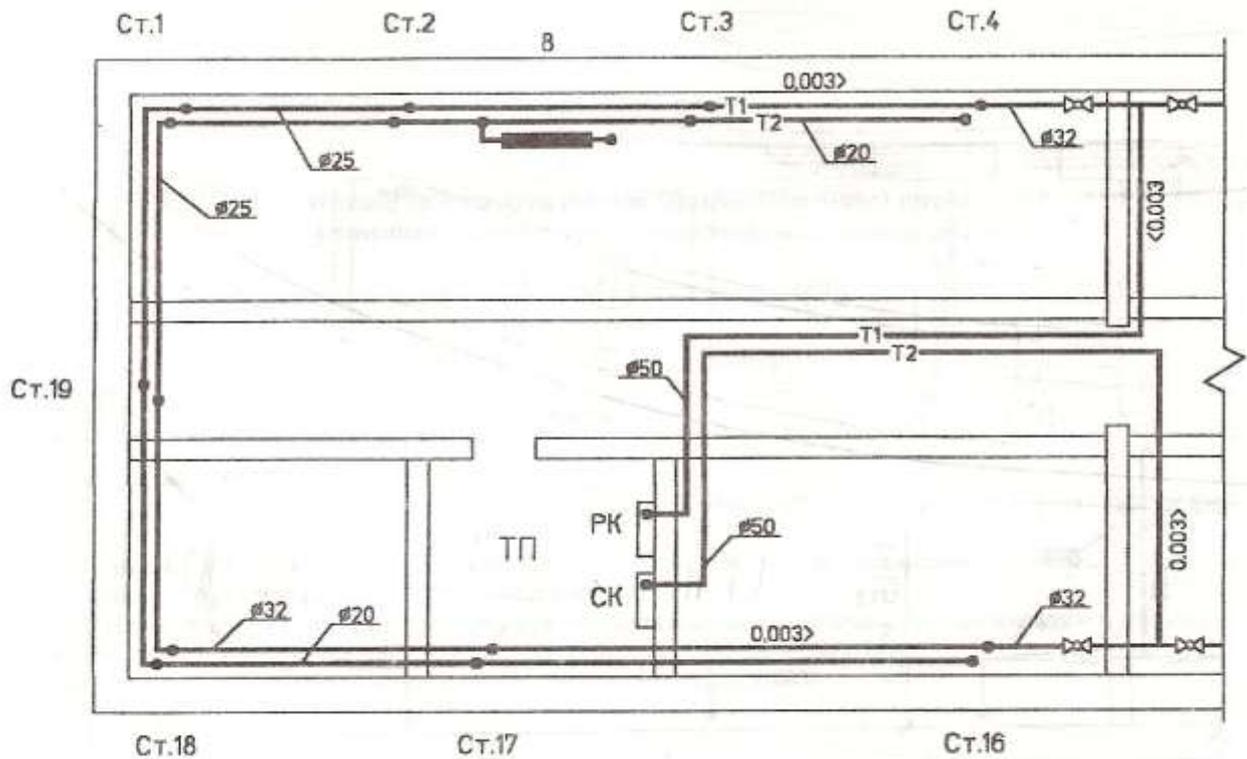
Размещение отопительного оборудования попутной системы с нижней разводкой на плане подвала (техподполья)
